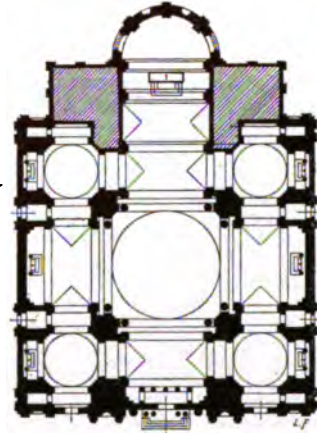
Grundriss des Duomo nuovo zu Brescia
